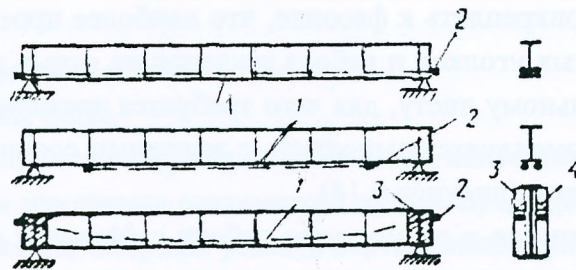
Схемы расположения гибких шпренгелей: 1 – кабель; 2 – анкер; 3 – железобетон; 4 – упор.
